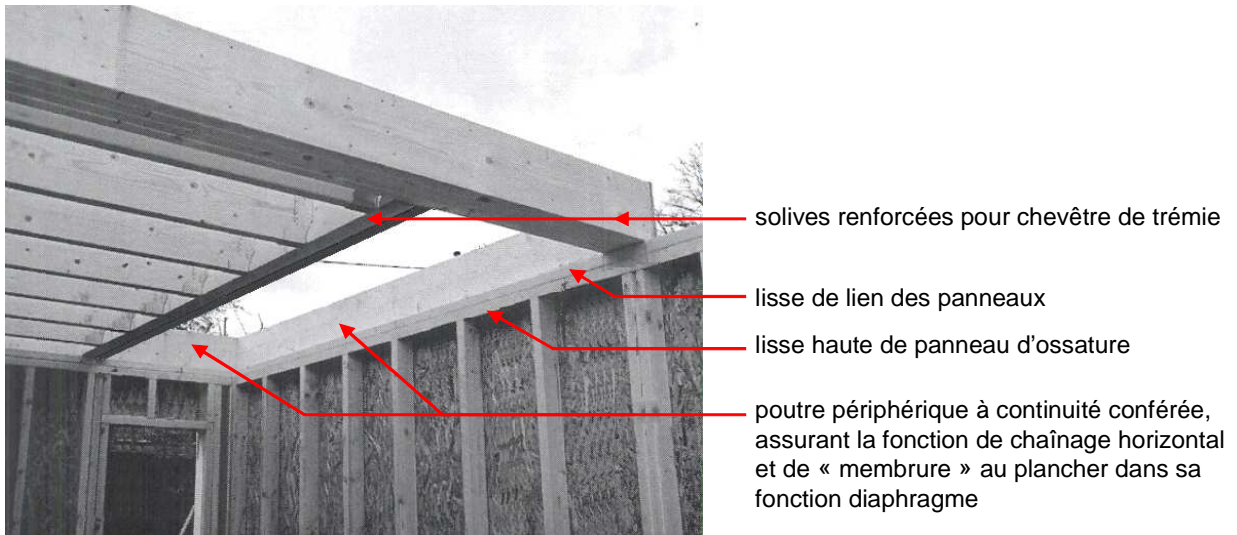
Configuration correcte d'un solivage au droit d'une trémie en périphérie de bâtiment
